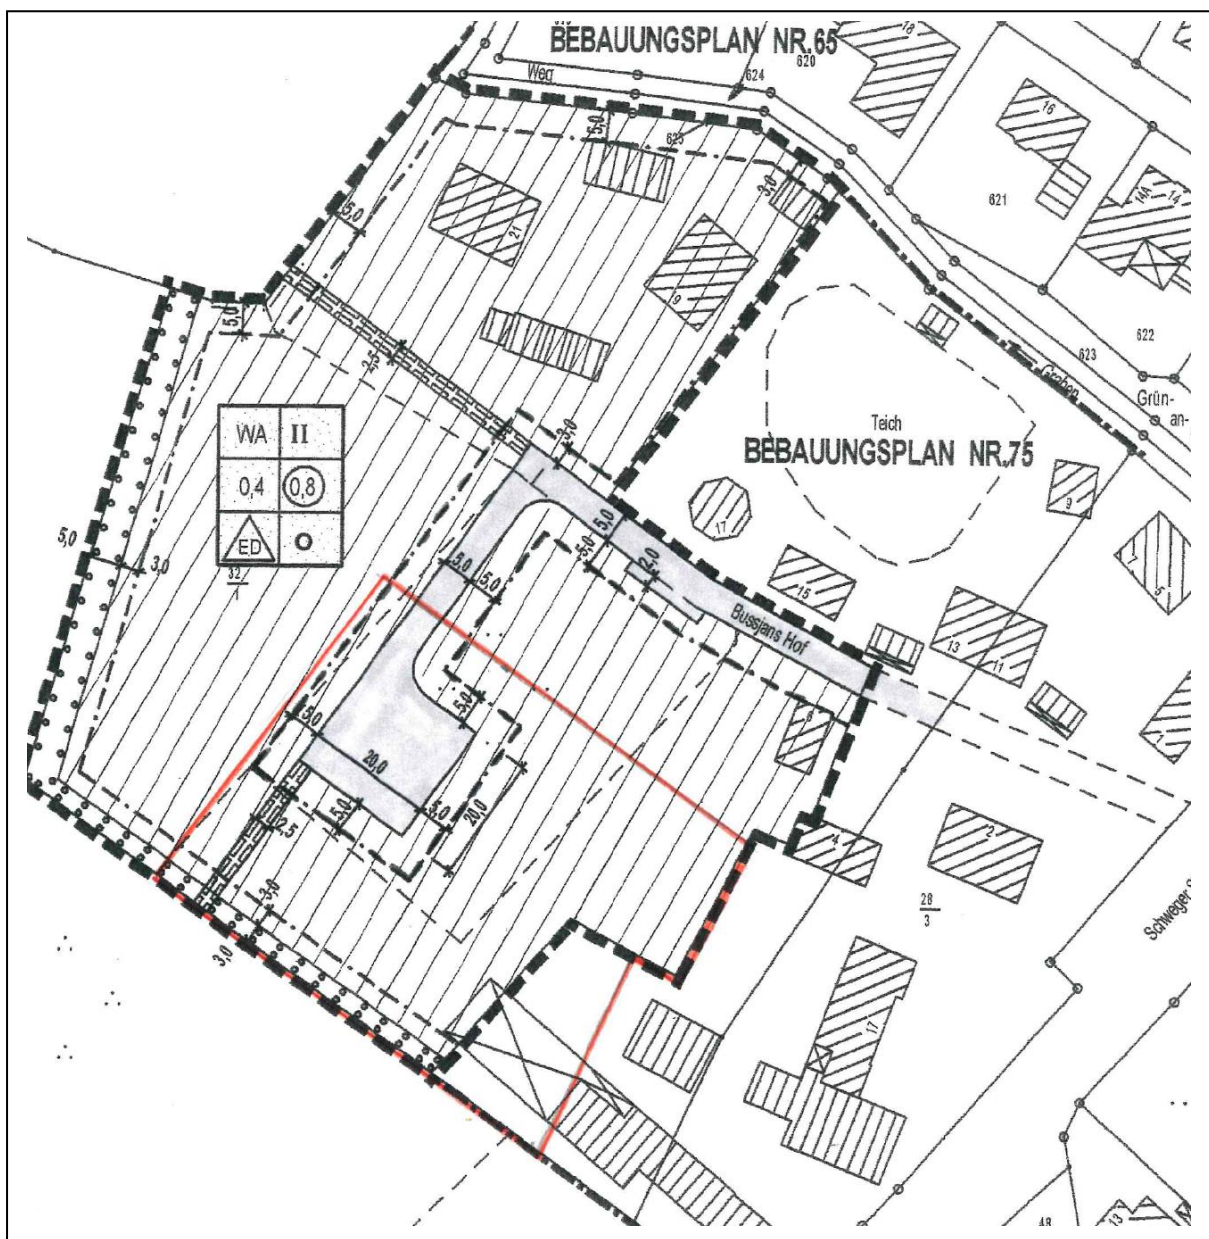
Bestandkräftiger Bebauungsplan – 1. Änderung - mit eingetragem Bereich der 2. Änderung
